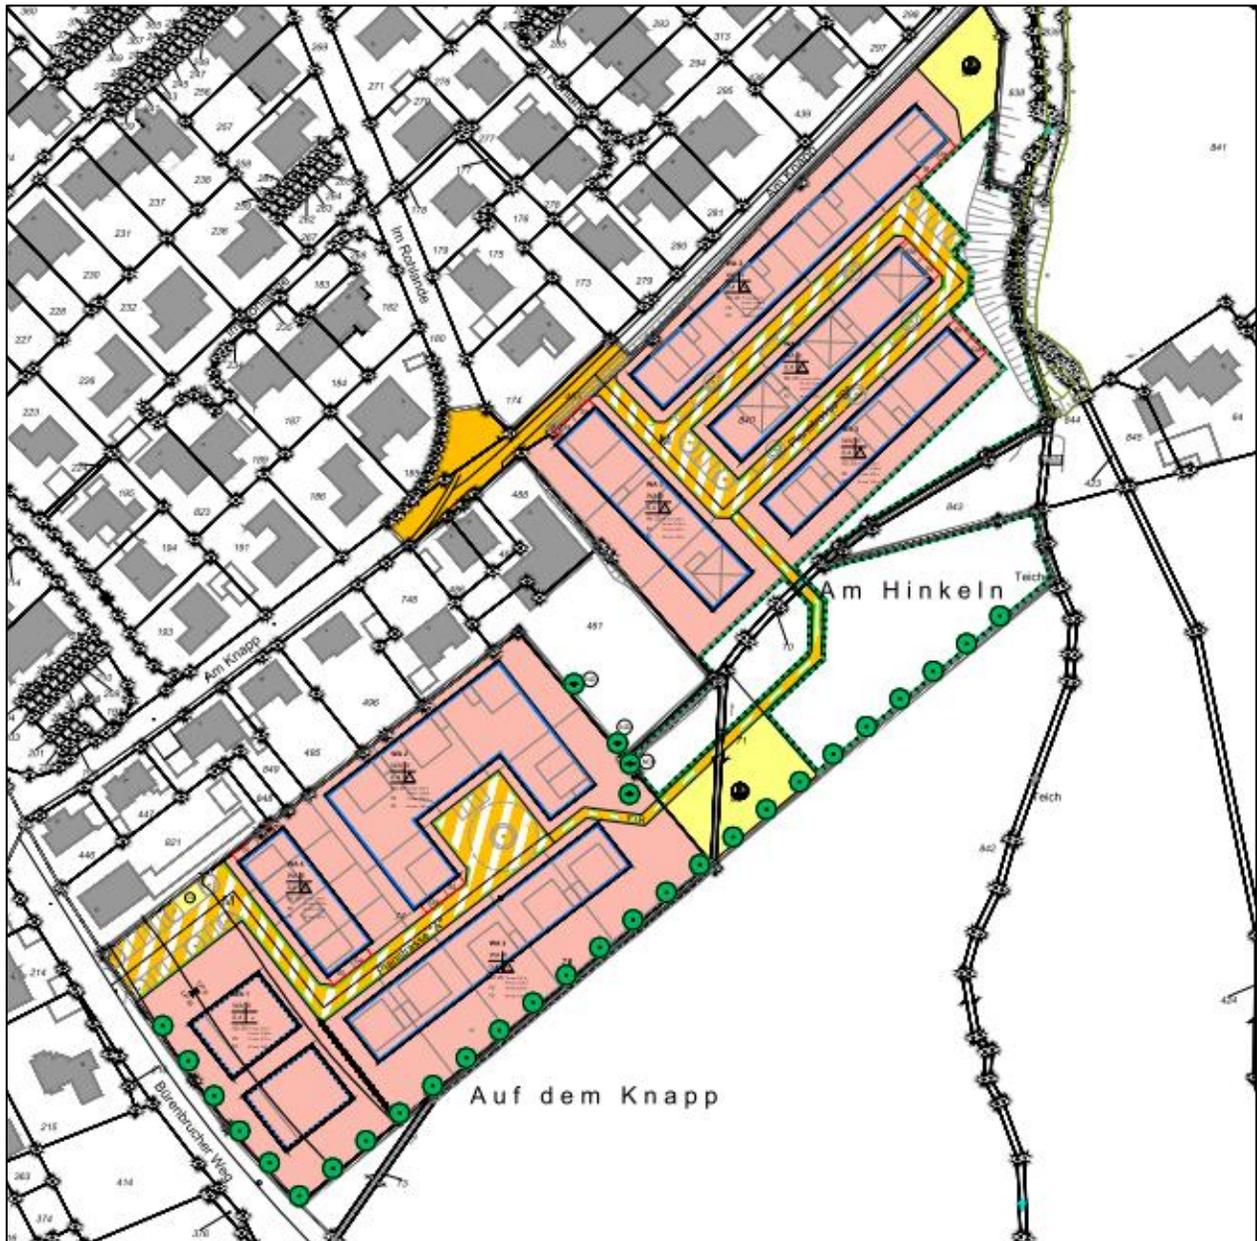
Auszug aus dem B-Plan (Bebauungsplan Nr. 187 „Auf dem Knapp / Am Hinkeln“ Entwurf, Stadt Schwerte)
